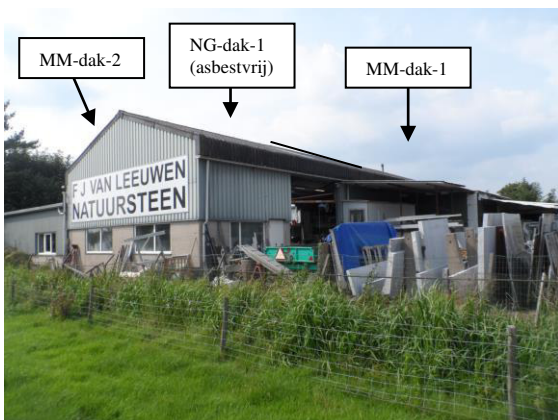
Geïntervieweerde kapconstructie/dakbedekking van de schuur met gedeeltelijk asbesthoudende en gedeeltelijk asbestvrije golfplaat dakbedekking vanuit zuidoostelijke richting gezien.
